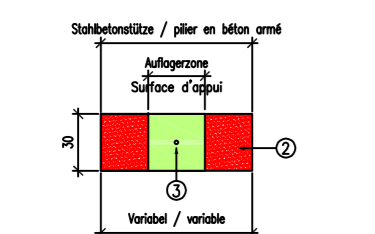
Stahlbetonstützen der Fassade Ost im Erdgeschoss und Zwischengeschoss
